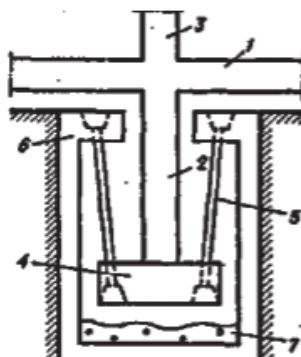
Сейсмоизолирующий фундамент с подвесными опорами
